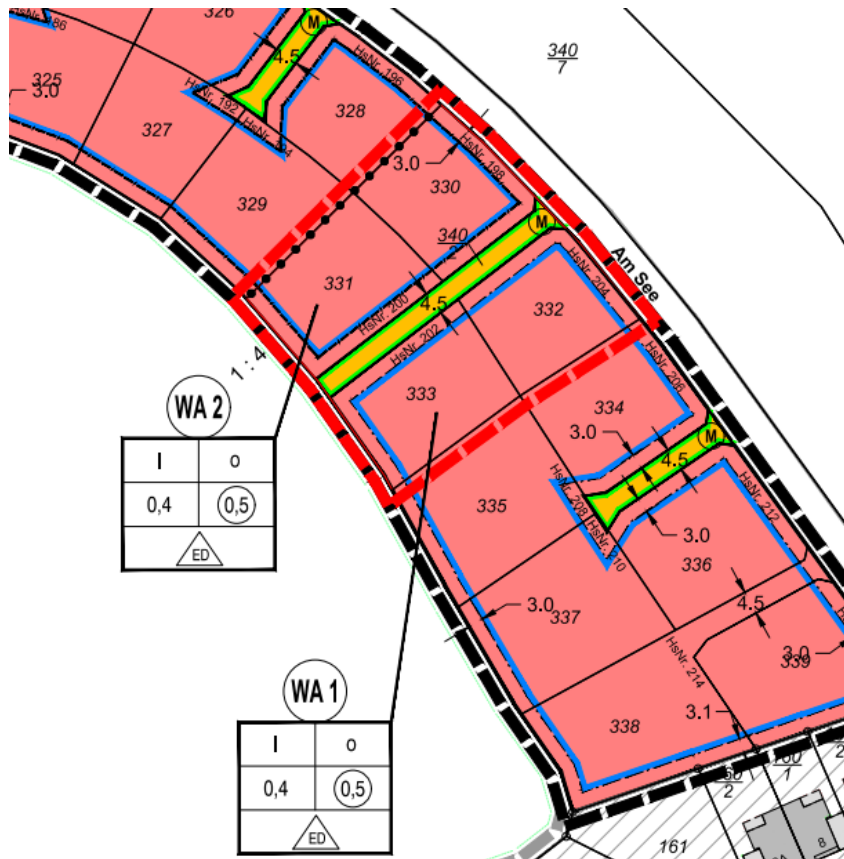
Planteil (rote Umrandung) 1. Änderung B-Plan Nr. 62 „Busemühle, 4. Erweiterung“
